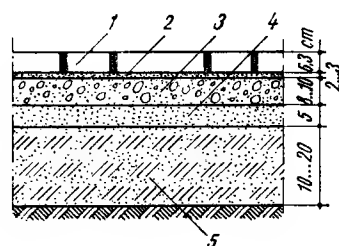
Pardoseală din cărămizi realizată la parter:
